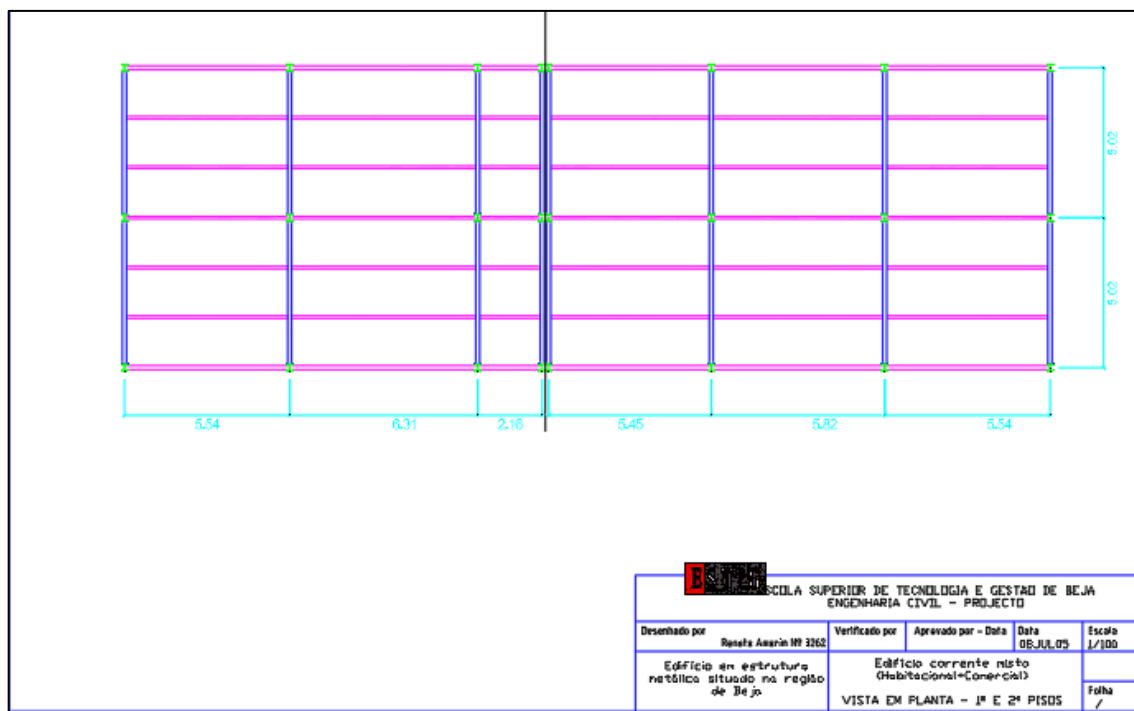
Planta dos pisos 1, 2 e 3 – Desenhos do AutoCad, segundo Amorim [8]
